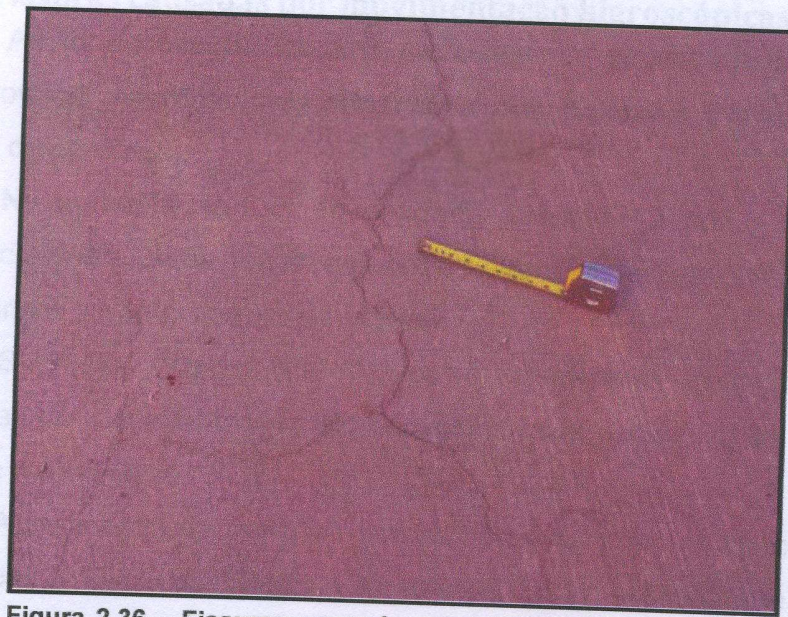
Fissuras causadas por expansão e contração térmica. (DEGUSSA, 2010).
